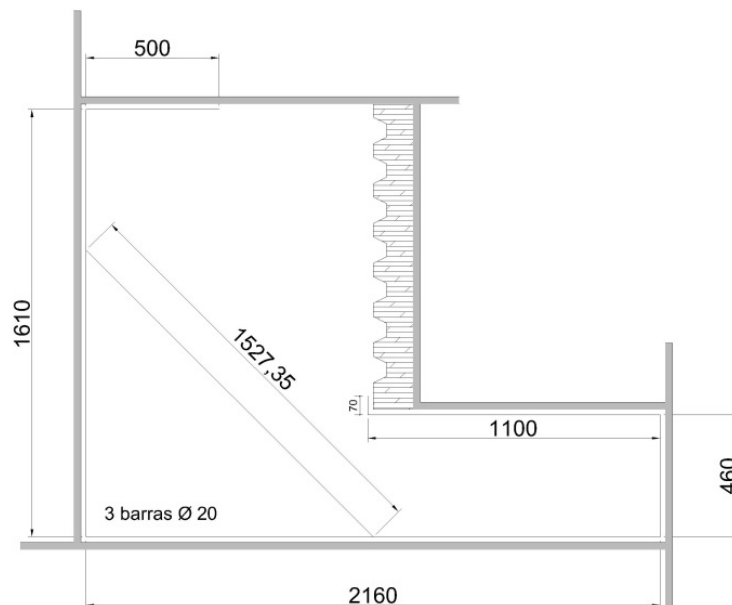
Disposición del encofrado para la fabricación de las piezas de hormigón para siete llaves (mm)
